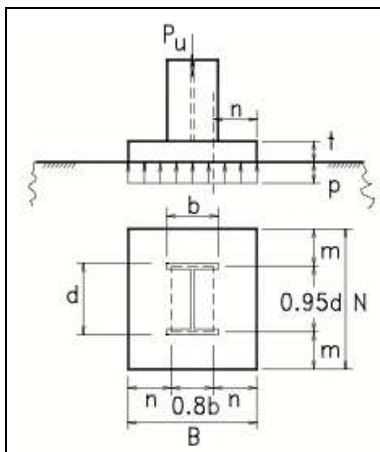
Diseño de Estructuras metálicas, Zapata Banglieto. Verificamos la Resistencia nominal del concreto contra el aplastamiento de la plancha:
